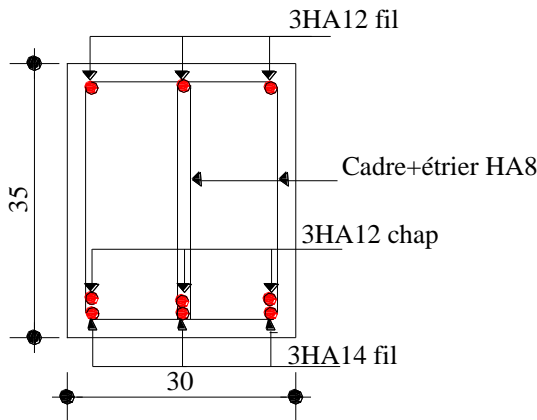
Schéma de ferrailage en appui de la poutre palière de l'escalier type2.
